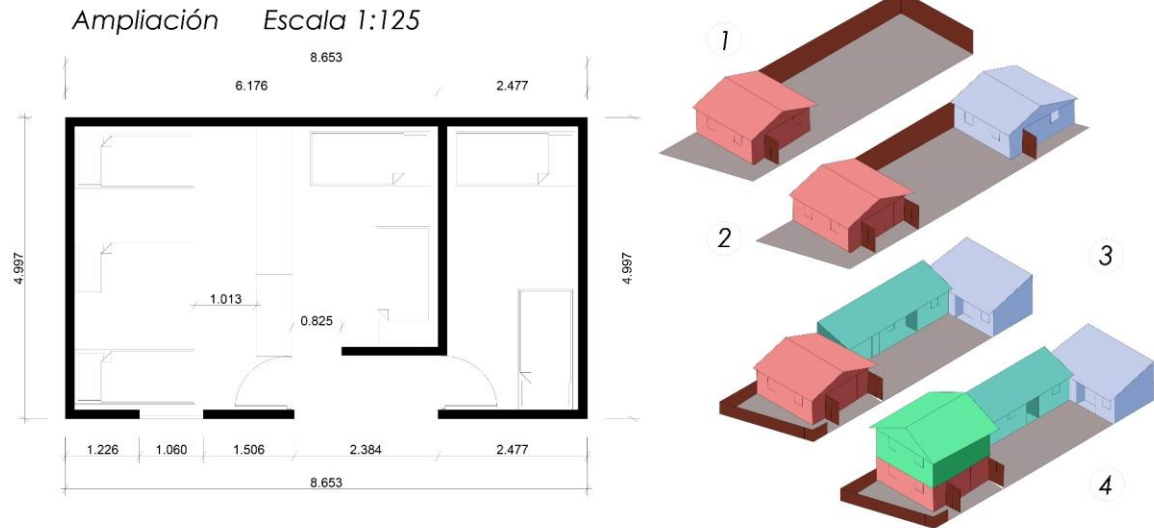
Autoconstrucción de las viviendas de la Villa la Reina, Chile.
